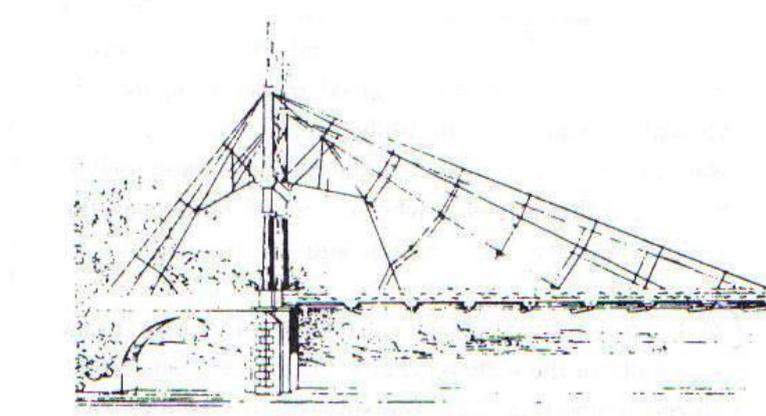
Puente sobre el Río Saale, Alemania, 1824
